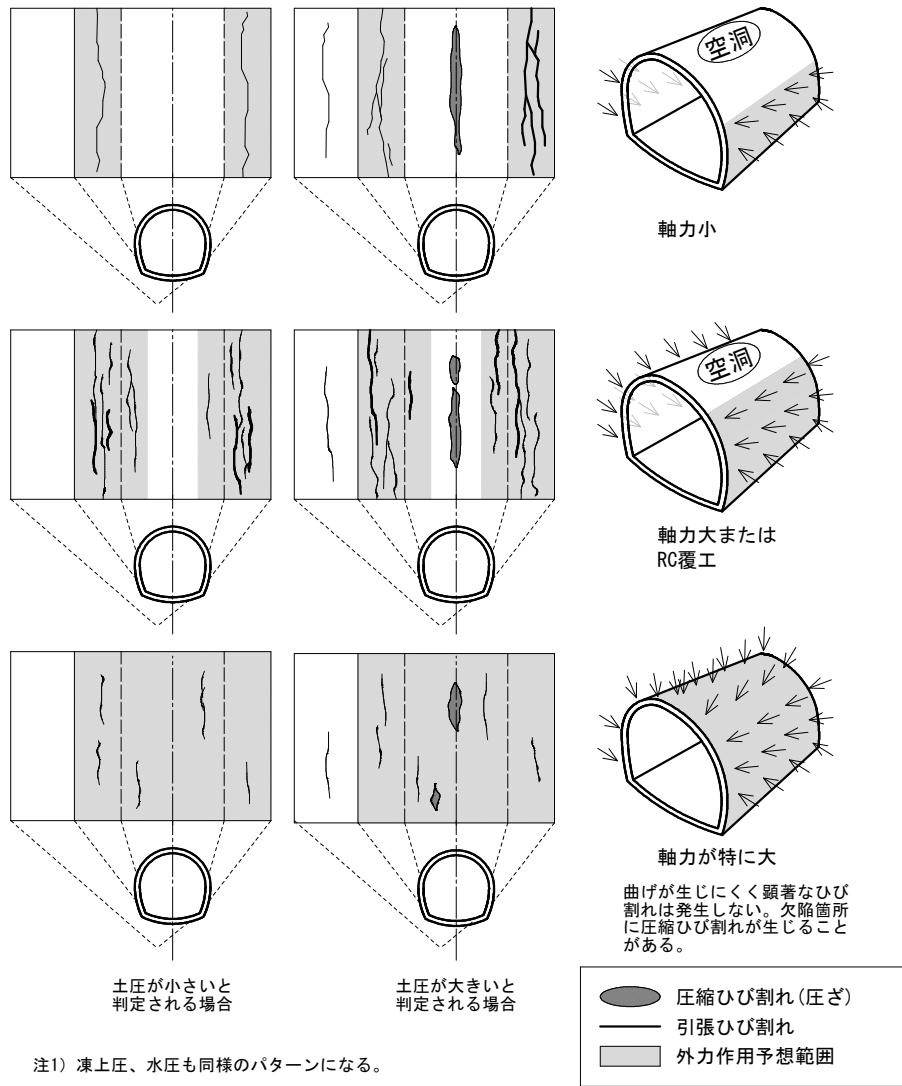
塑性圧によるひび割れパターン図
